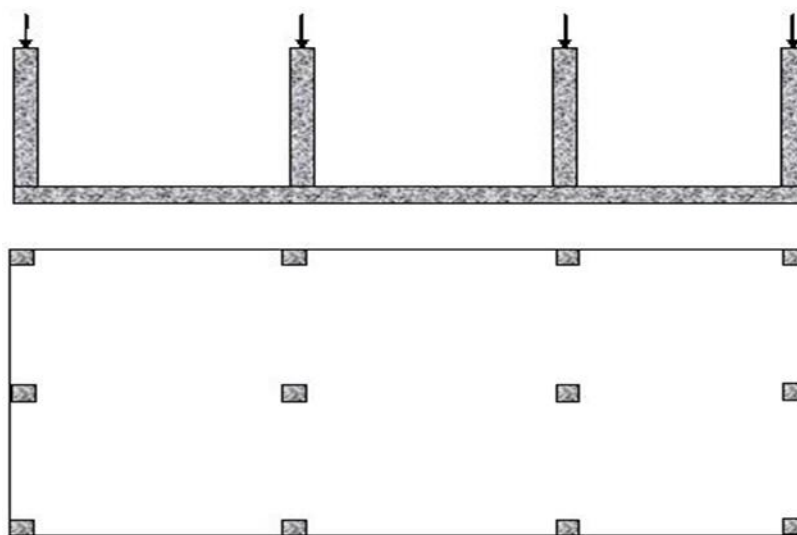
Losa de cimentación. (Fuente: Martínez, 2003.)
